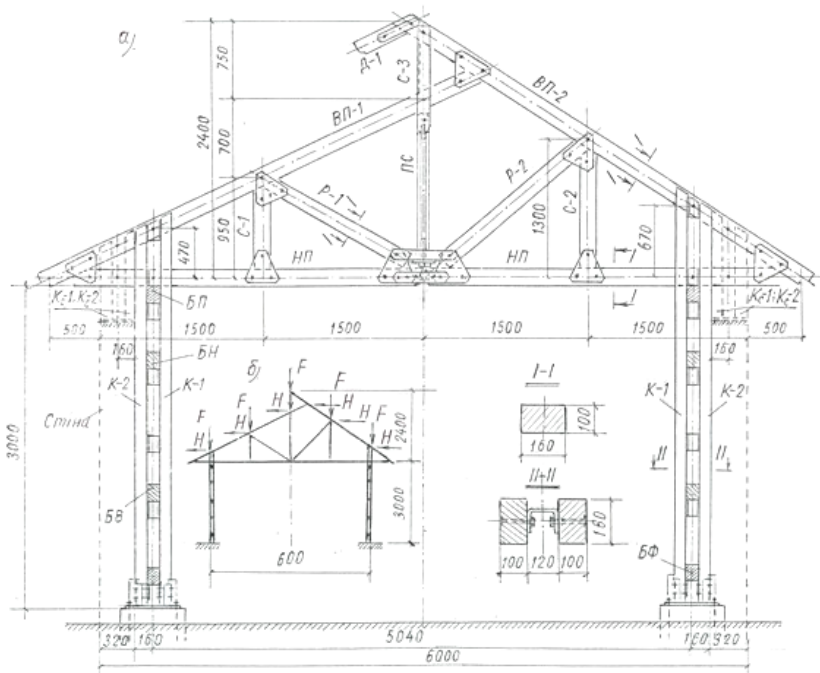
Дослідна конструкція рами каркасу одноповерхового будинку прольотом 6,0 м з однотипних збірних залізобетонних елементів перерізом 160х100 мм: К-1 і К-2 – збірні елементи двовіткових колон; БФ, БВ; БН і ПБ – фундаментні, віконні, надвіконні і підкроквяні балки стінових рам; НП; ВП-1; ВП-2; С-1; С-2; Р-1 і Р-2 елементи ригеля рами у виді трикутних ферм
